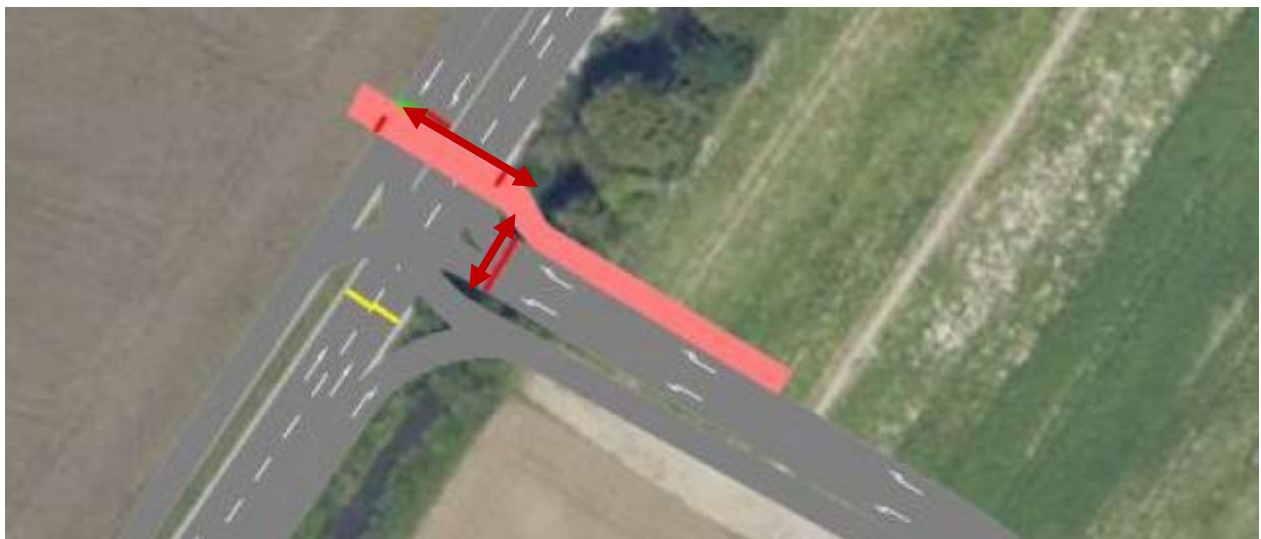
Grober Entwurf signalisierter Knotenausbau B301/ Planstraße (Obermeyer, 2025) mit zusätzlicher Querungsmöglichkeit über die Planstraße
